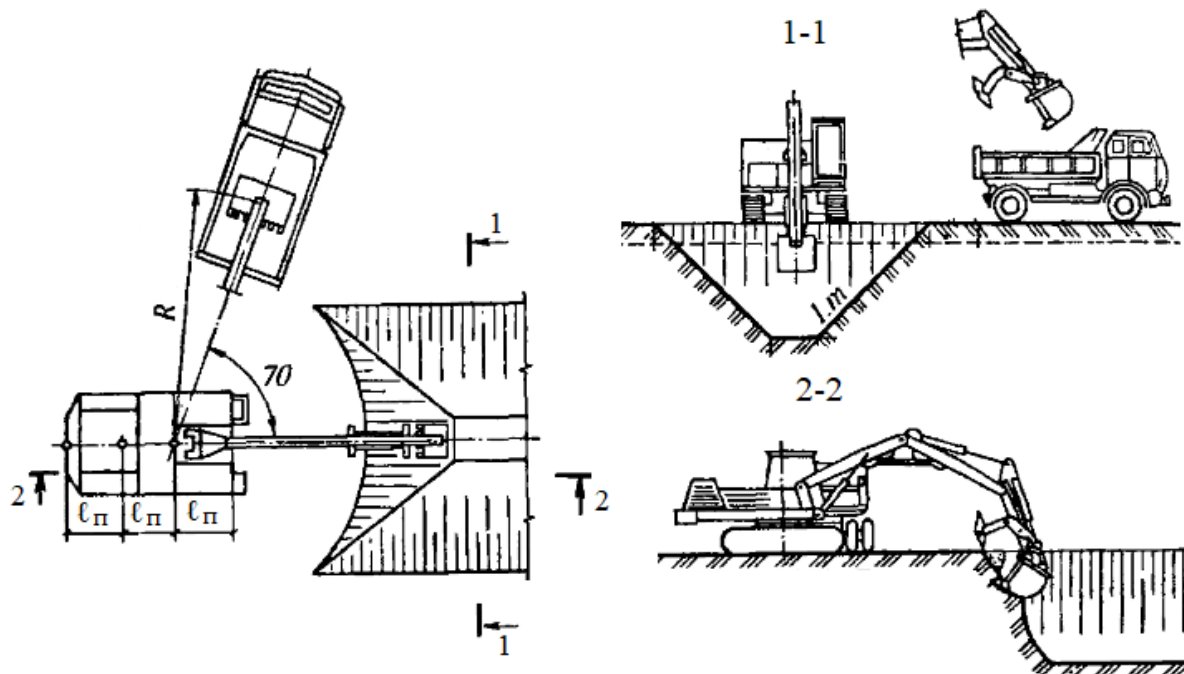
Схема разработки грунта в траншее экскаватором с обратной лопатой
